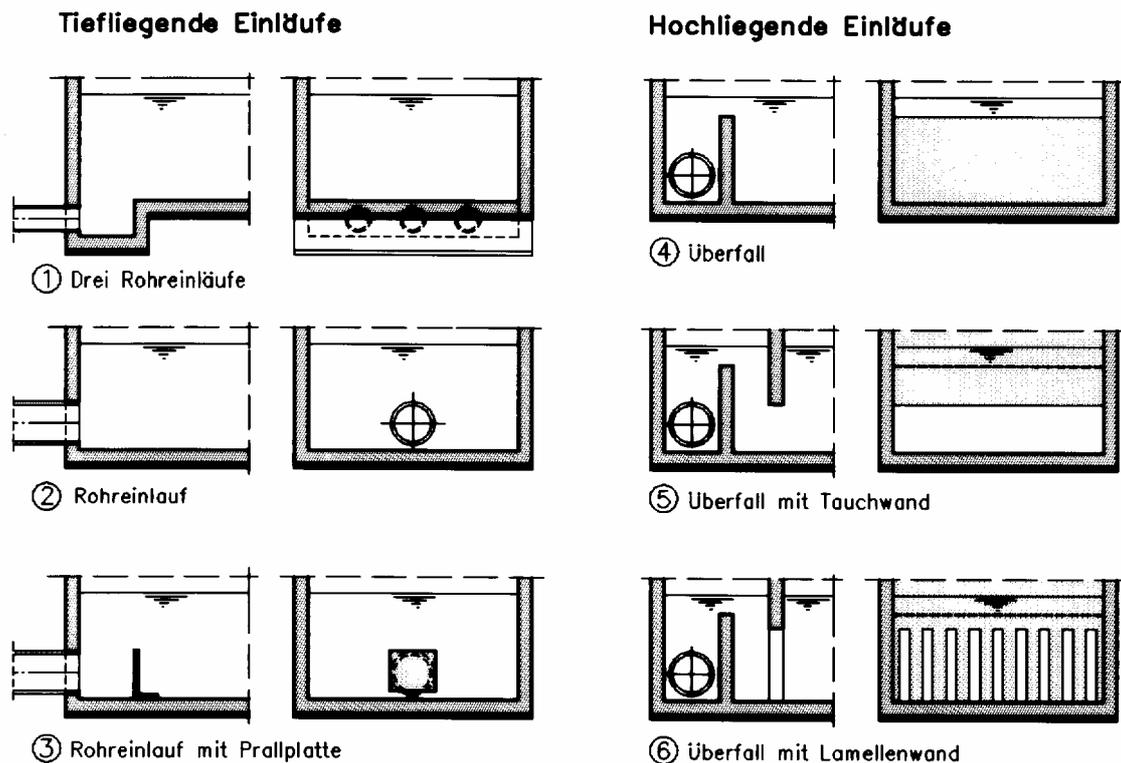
Varianten der Einlaufgestaltung bei Durchlaufbecken
